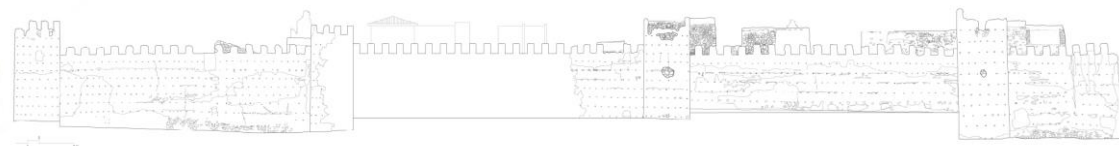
Alzado Norte. Escala 1/550. Fuente: Autora.
